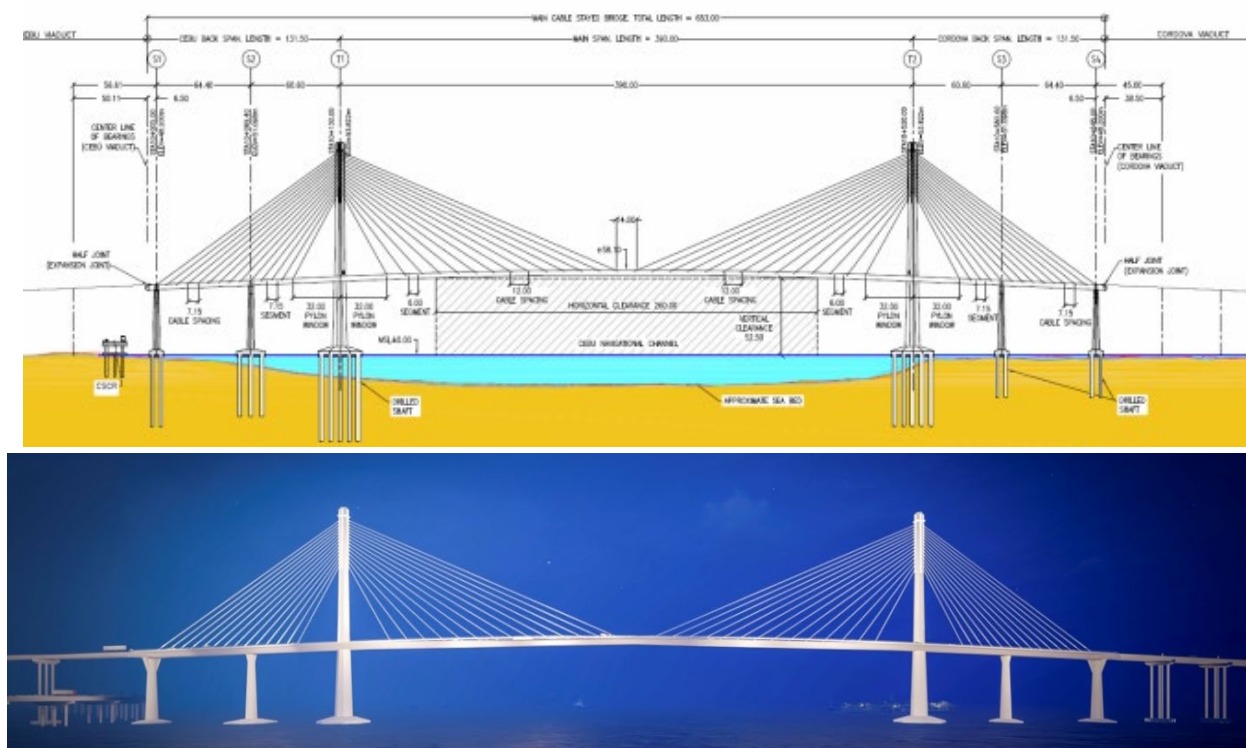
Alzado y vista frontal del puente, diseño de detalle.
